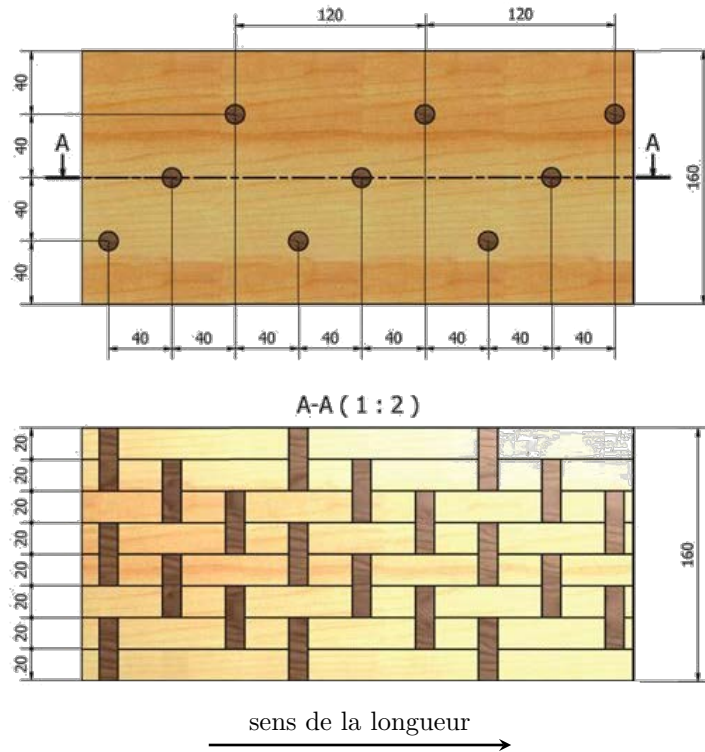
Disposition des tourillons soudés
